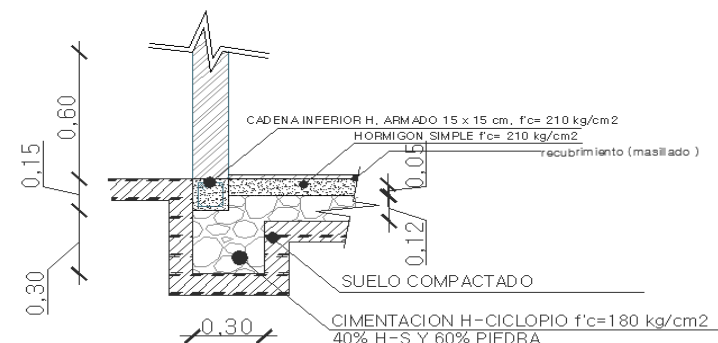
Detalle constructivo Suelos - Vivienda Rural MIDUVI
